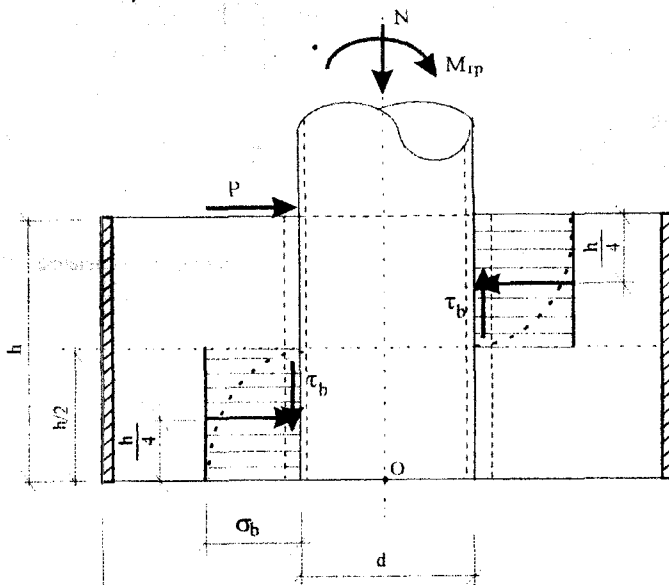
Розрахункова схема зусиль у стакані стабетонного фундаменту під грубобетонні колони
